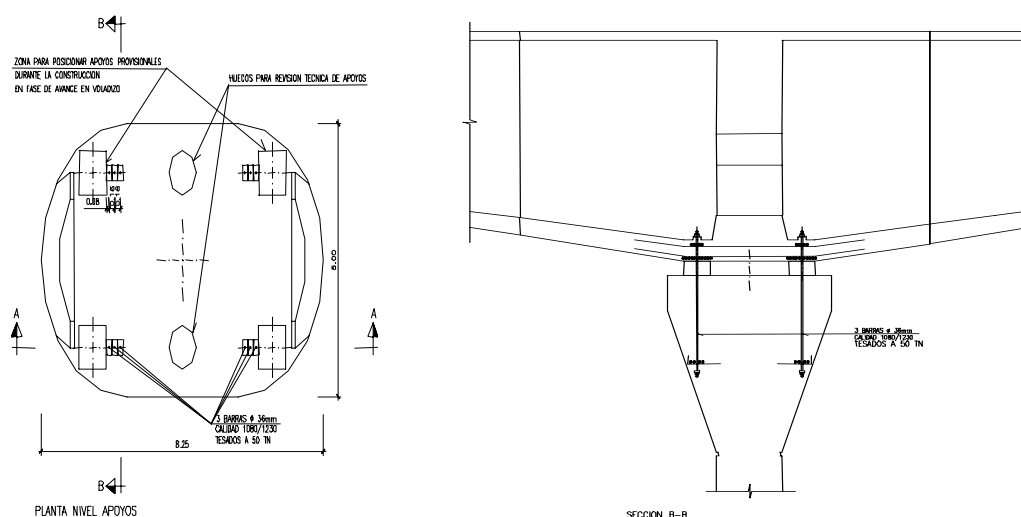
Dispositivos de empotramiento provisional en pila para la construcción de los vanos en voladizos sucesivos según propuesta en proyecto.
